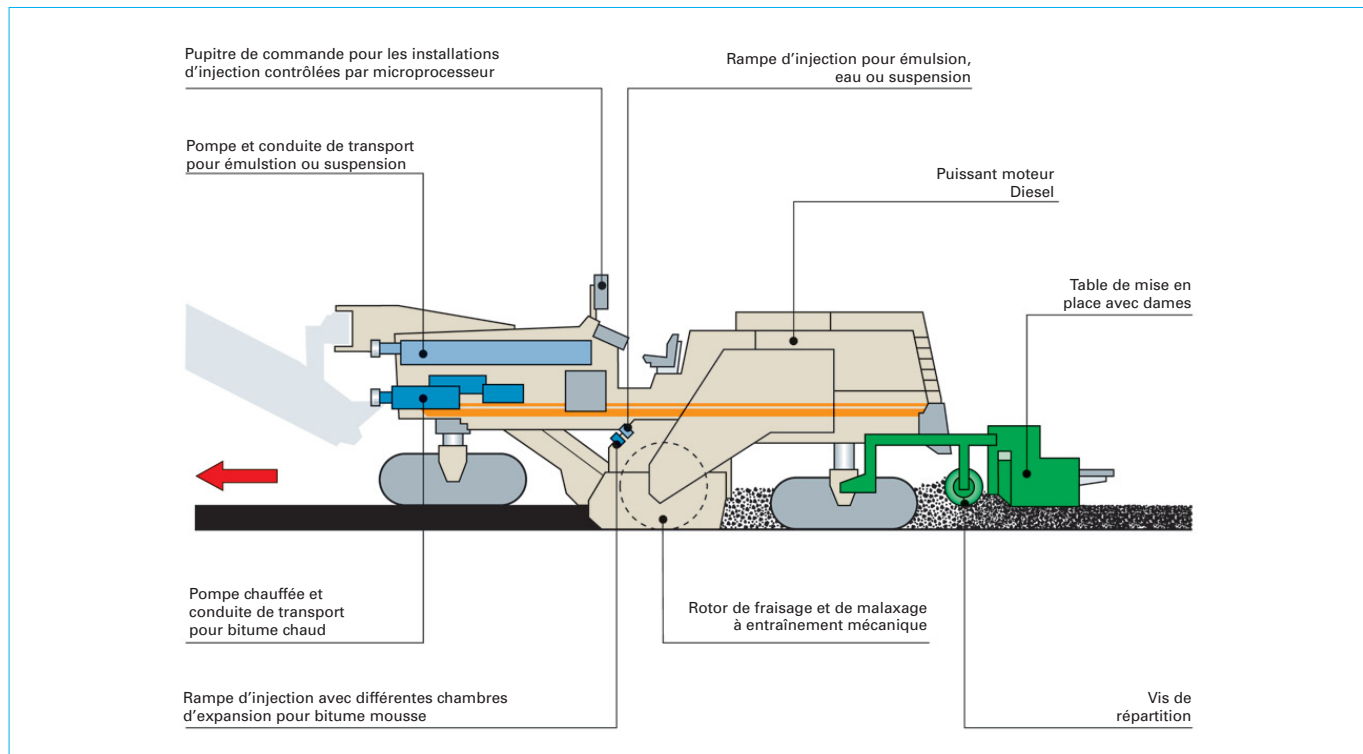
Schéma de principe d'une machine fraiseuse/malaxeuse (crédit Wirtgen)
